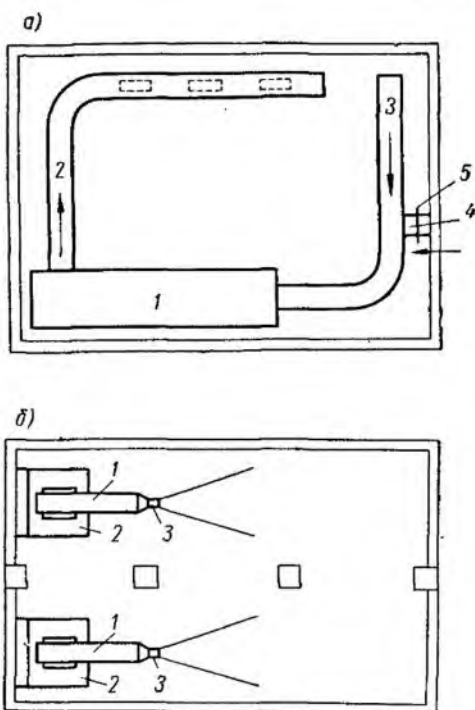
Схемы воздушного охлаждения: а — с двухканальным распределением воздуха: 1 — воздухоохладитель; 2 — нагнетательный воздуховод; 3 — всасывающий воздуховод; 4 — канал для подачи наружного воздуха; 5 — шиббер регулировки подачи свежего воздуха; б — с бесканальным распределением воздуха: 1 — вентилятор; 2 — воздухоохладитель; 3 — сопло
